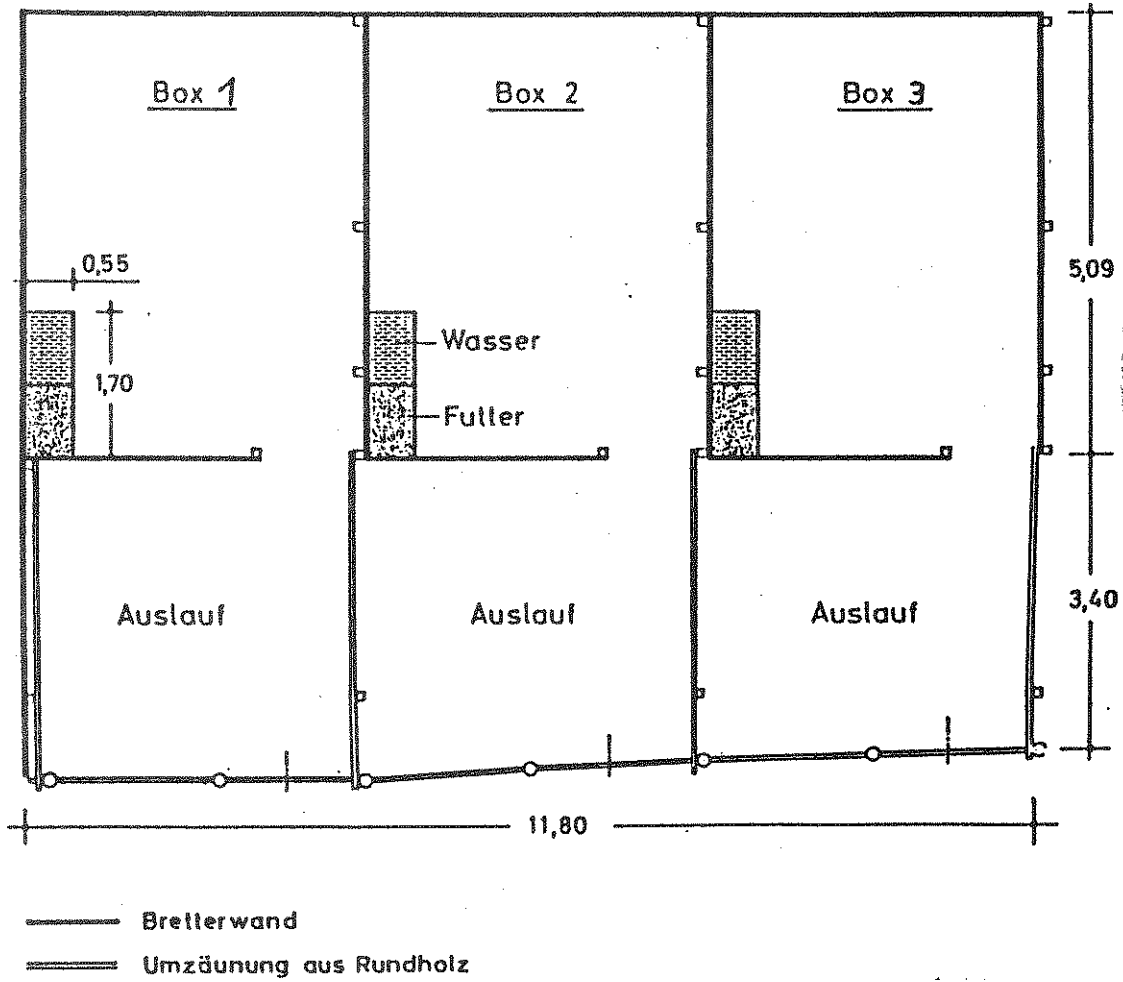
Versuchsboxen mit Auslauf in einem nicht wärmegeämmten Gebäude (KRÄCKL (9)).
